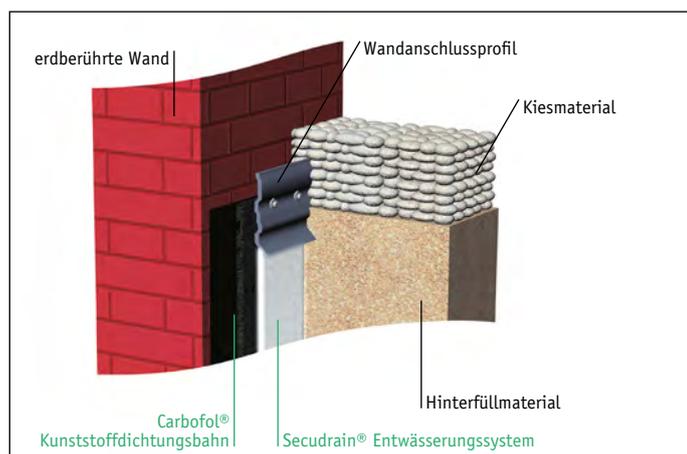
Bauwerkentwässerung (Detail Wandabschluss)
